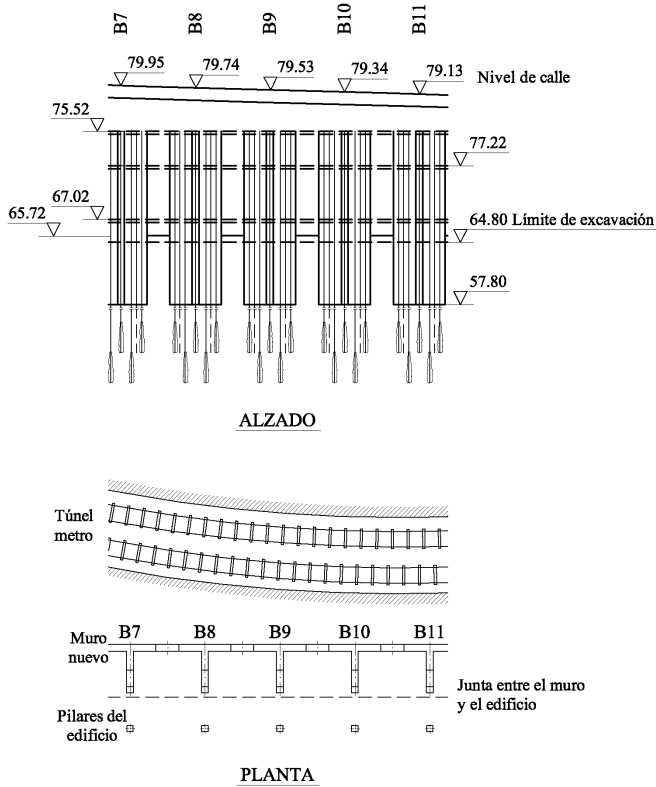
Planta y alzado del muro pantalla con contrafuertes.
